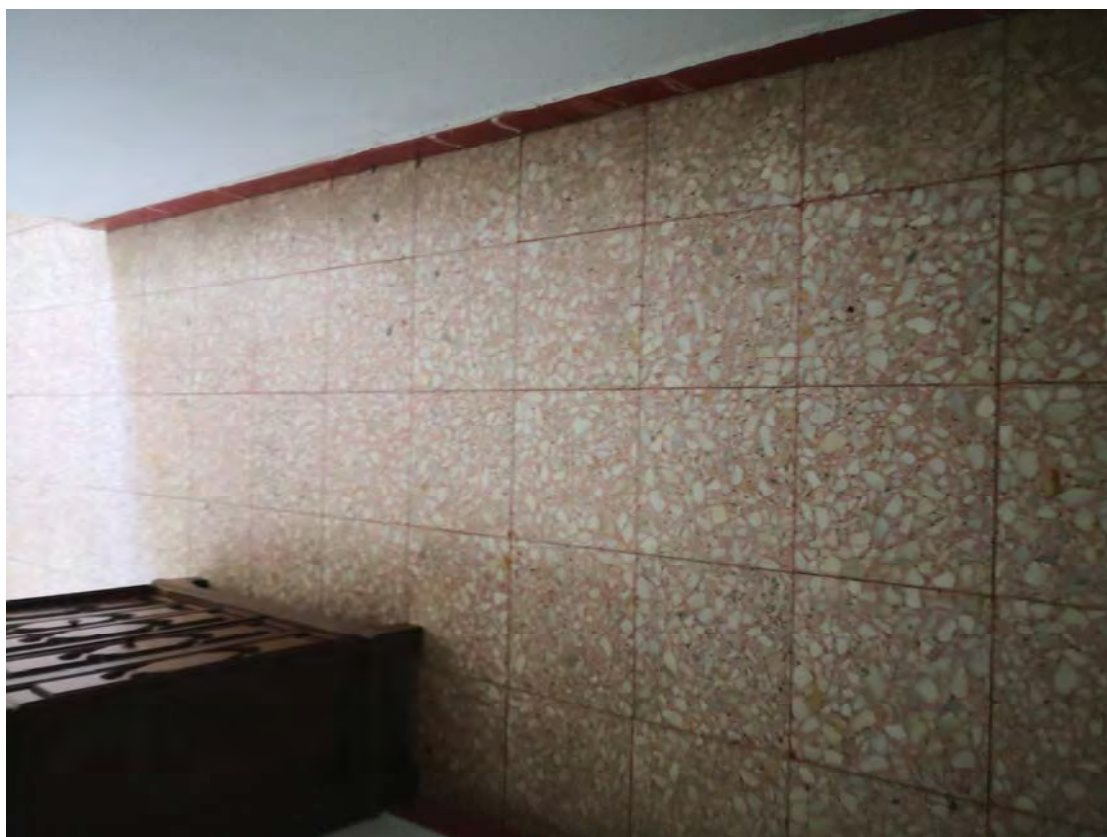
e 21 - *corridoio disimpegno piano primo
